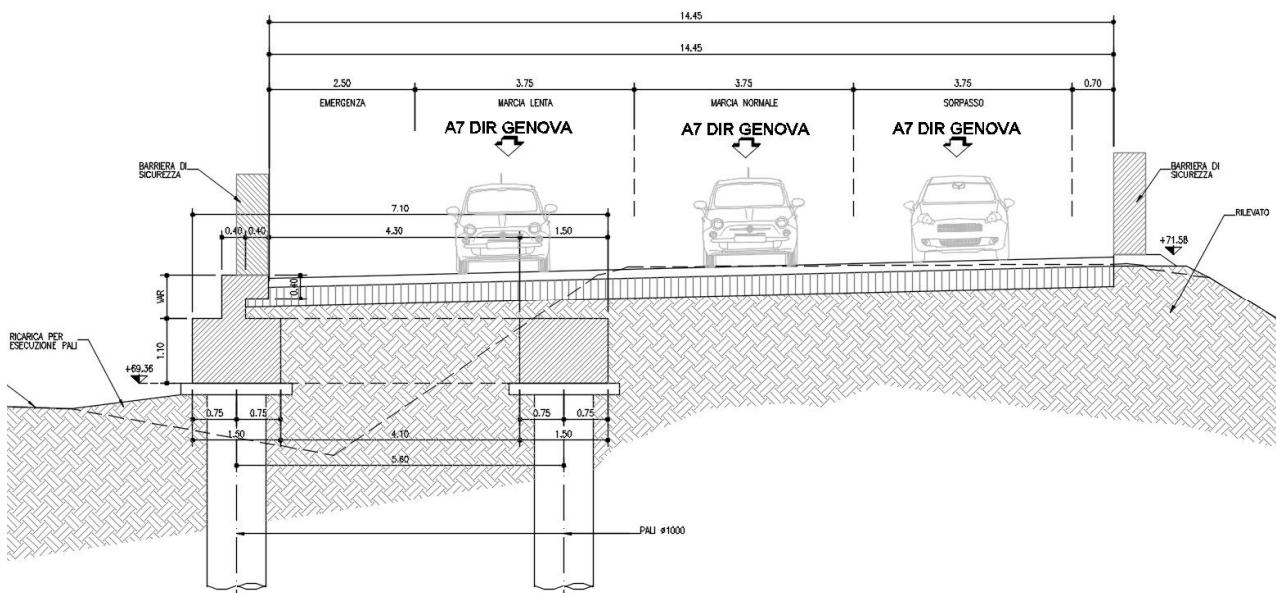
Spalla lato Milano - Sezione trasversale zona pali di ancoraggio
